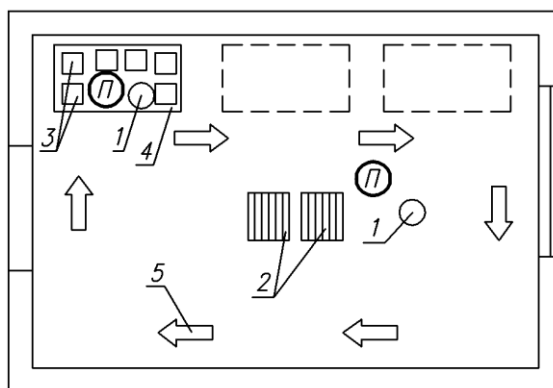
Схема организации работ при устройстве плиточных облицовок стен.
